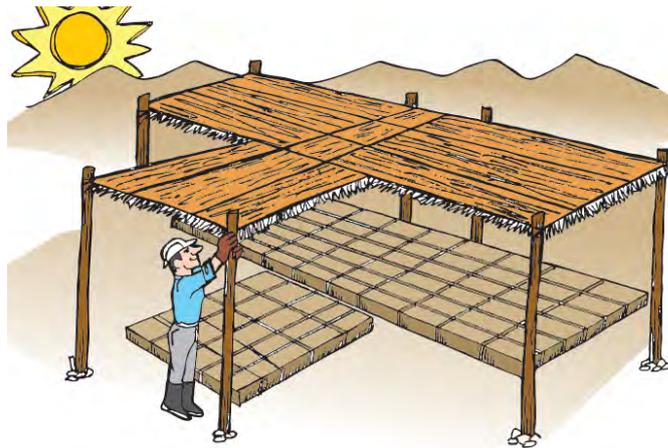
Tendal protegido con esteras para el secado adecuado del adobe.
